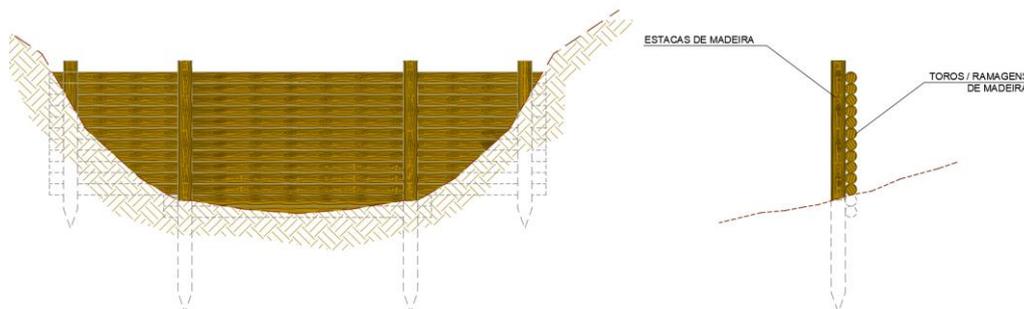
Exemplo de uma paliçada de madeira – vista frontal e corte.
